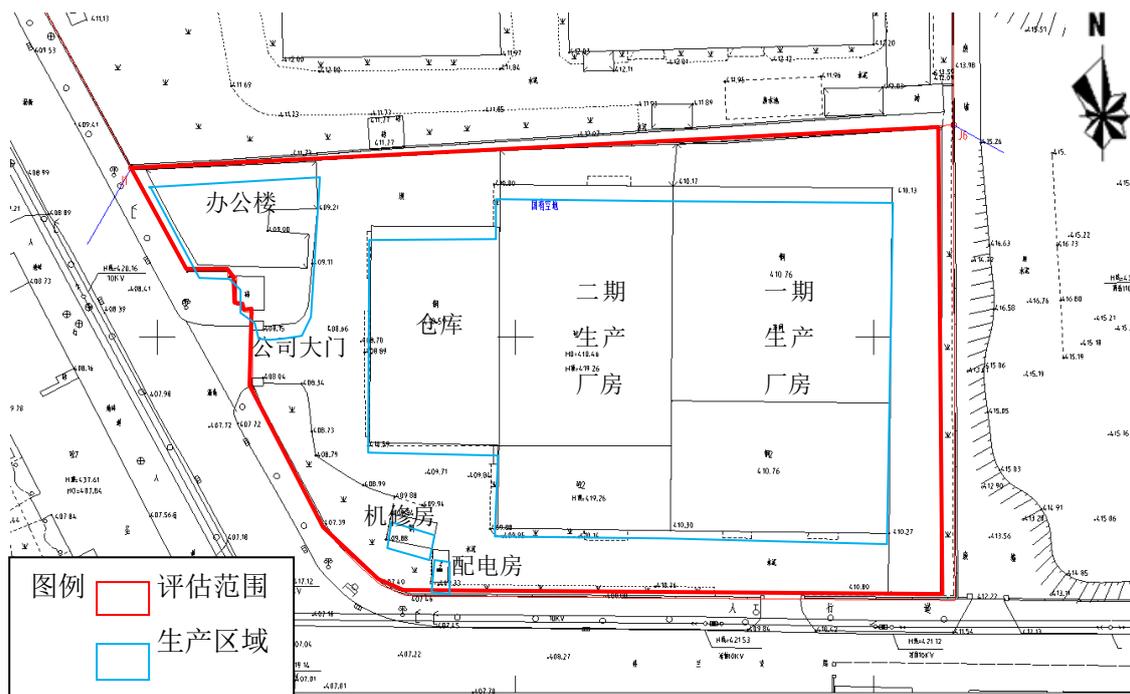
重庆安迪车用材料有限公司生产布局平面图
